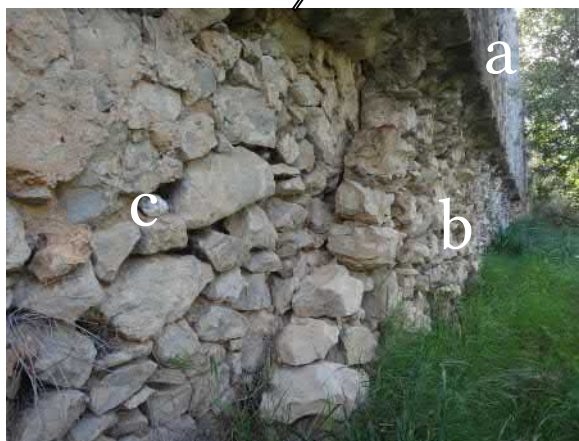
La muraille de Terracine : arrachement du muret externe entre T5 et T6
